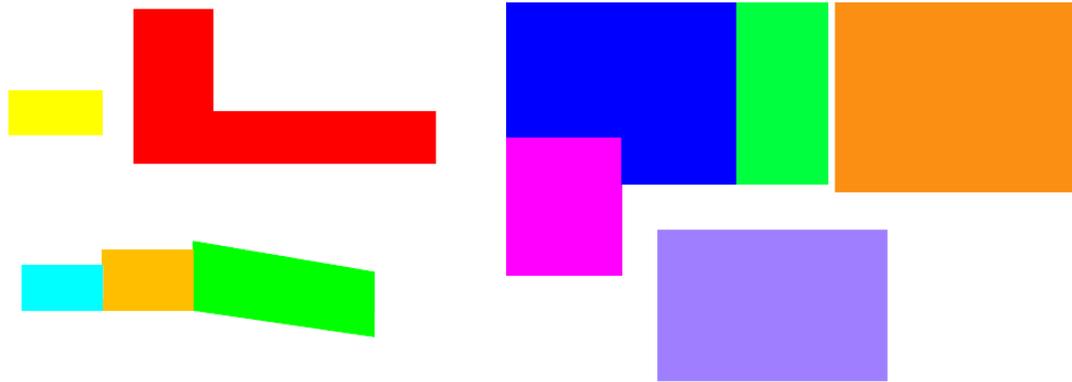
Distribución de las áreas correspondientes a la Planta Baja del Museo.
